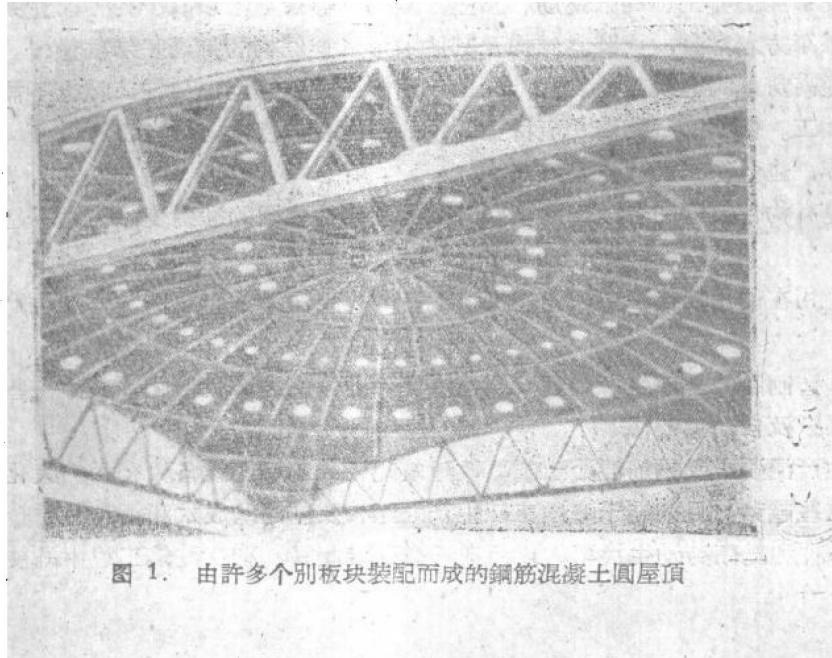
由许多个别板块装配而成的钢筋混凝土圆屋顶
